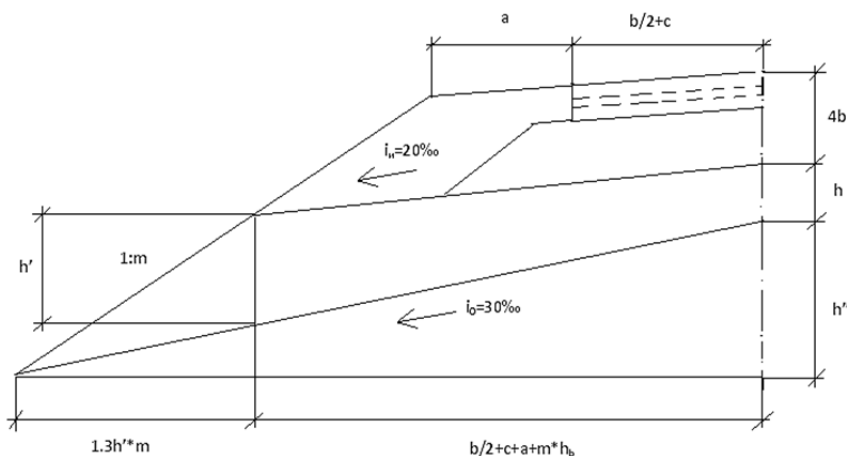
Схема для расчета площади поперечного сечения песчаного слоя
